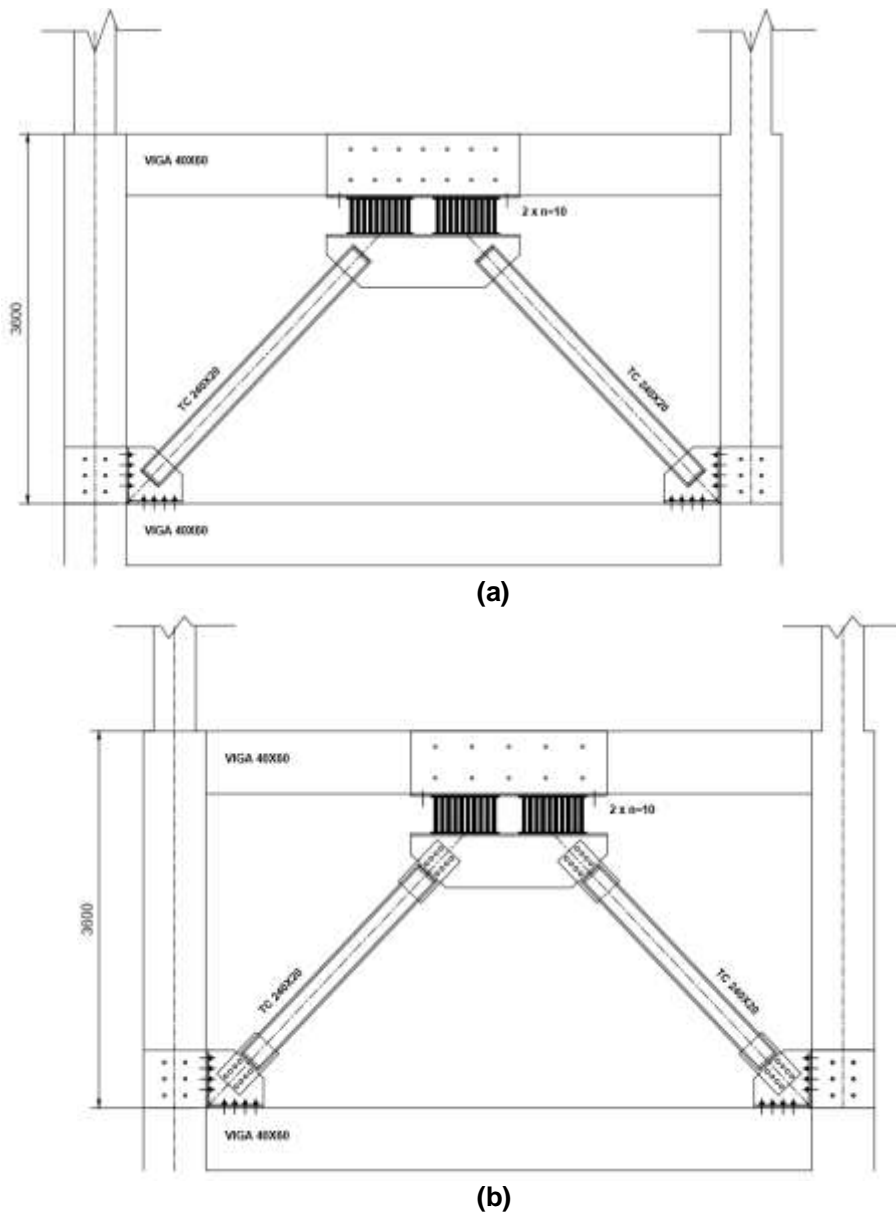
Dos conexiones de diagonal tubular, redonda o cuadrada a placa Gusset inferior y superior; a) Conexión soldada; b) Conexión soldada-apernada.
